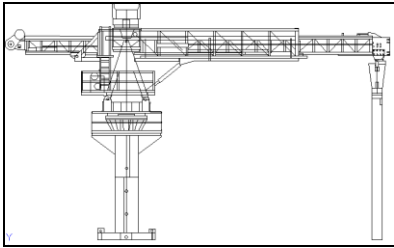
Detalle del *Swinger* ROTEC, para la distribución de RCC
